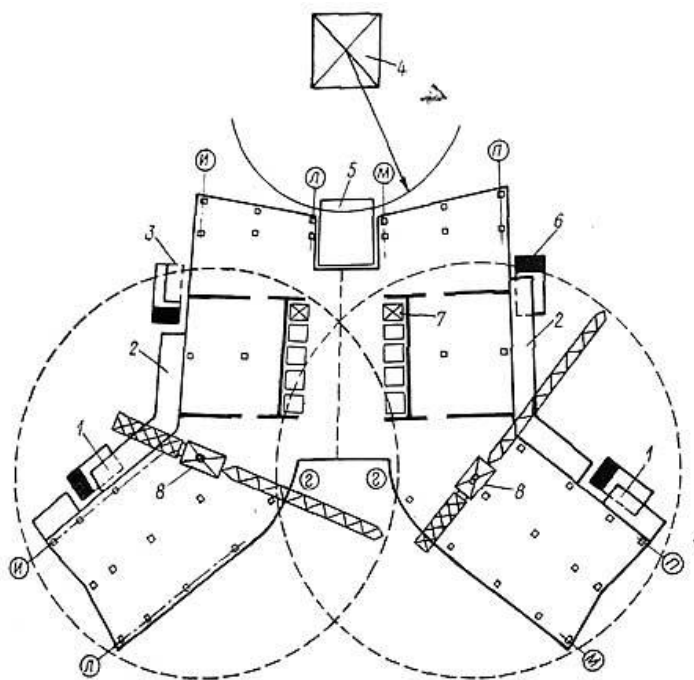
Схема установки механизмов при строительстве здания СЭВ: 1, 3, 6 — подъемники; 2 — защитный козырек; 4 — кран СБК-300; 5 — выносная площадка на отметке; 7 — бетоноподъемник; 8 — самоподъемные краны СБК-Ю-5
